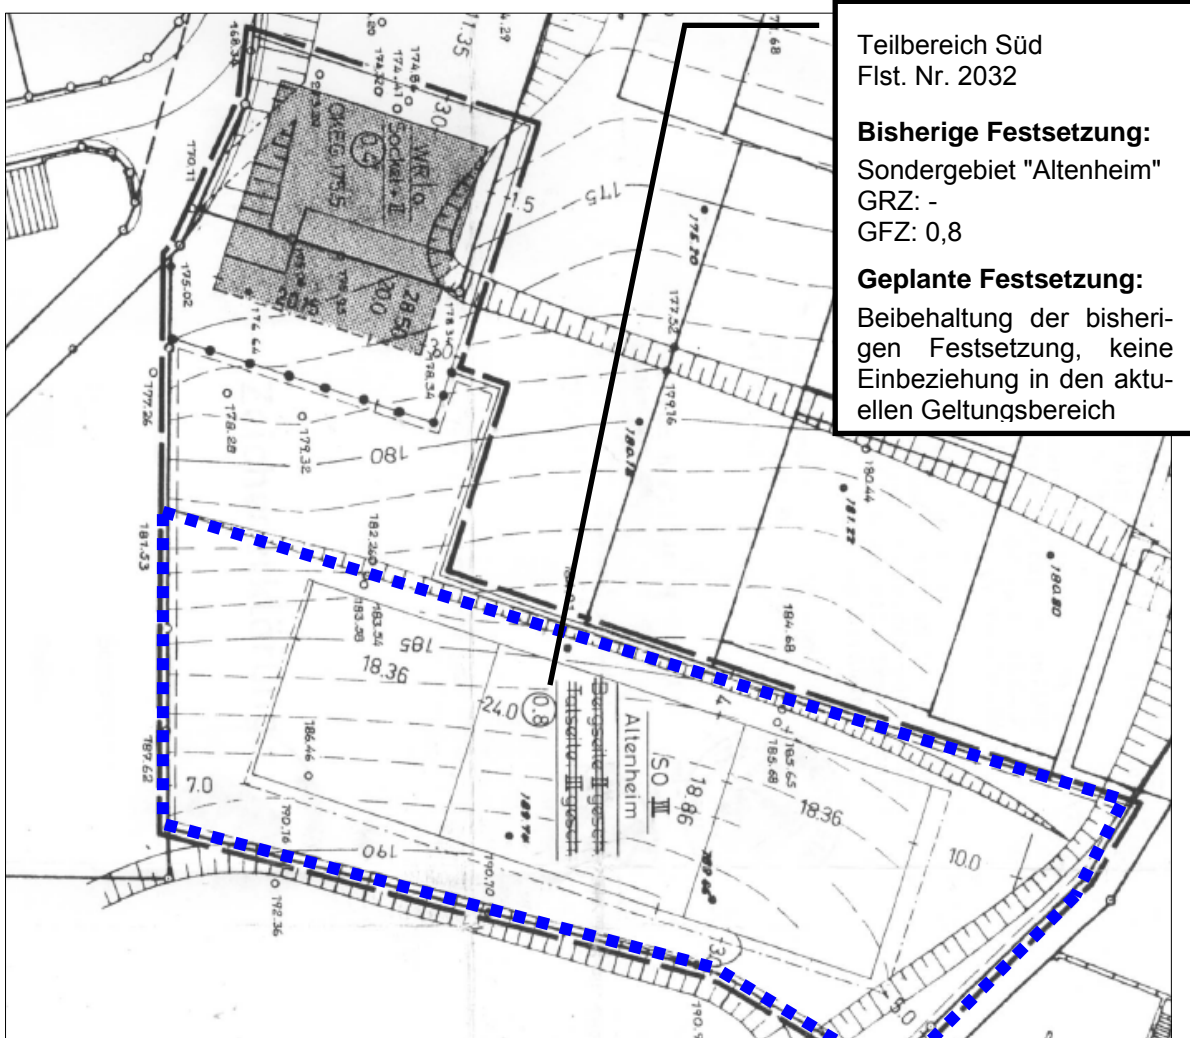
Ausschnitt 2 aus dem B-Plan Nr. 056
